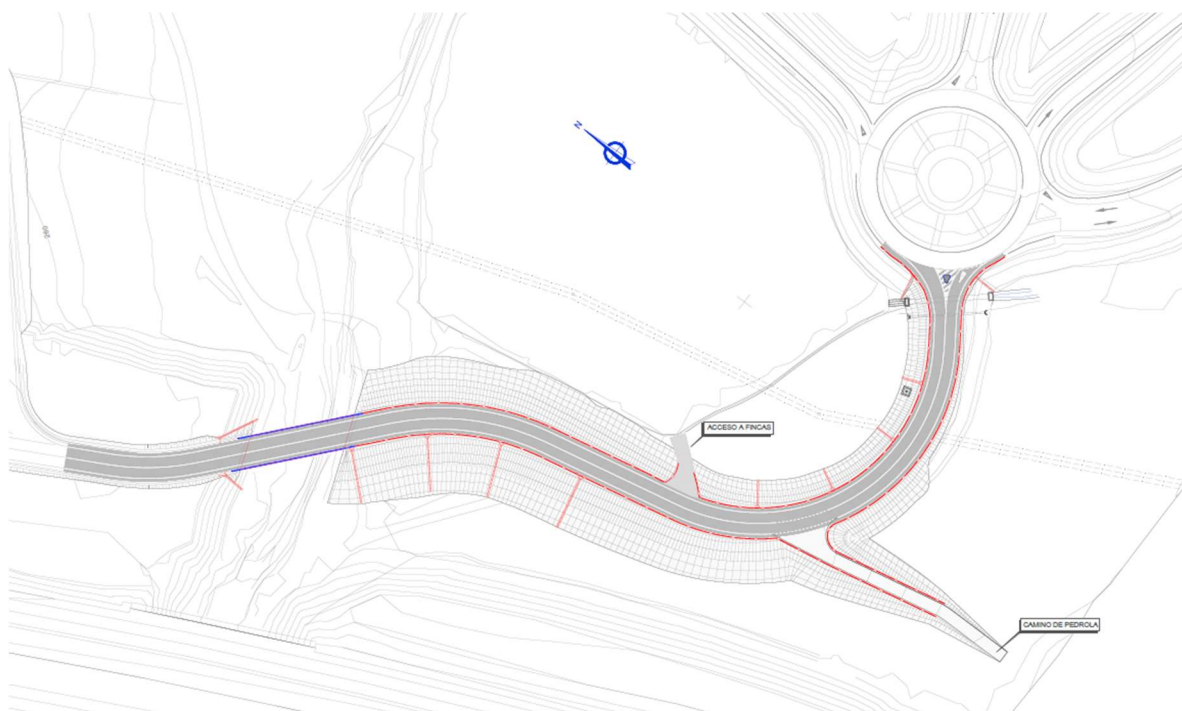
Planta proyectada del ramal de conexión con la A-68
